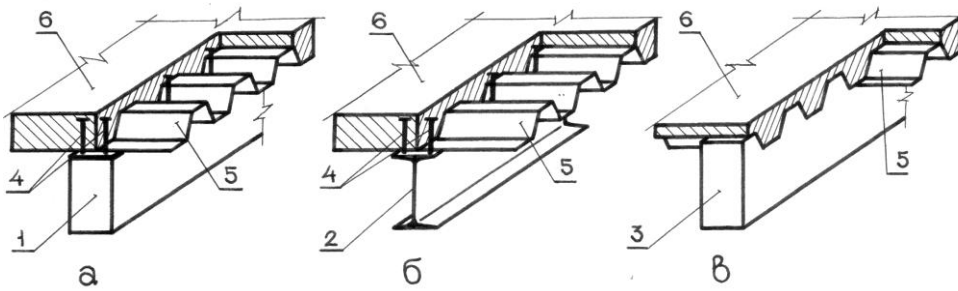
Комбіноване перекриття поверх профільованого настилу з використанням: а – сталевих залізобетонних балок; б – сталевих двотаврів; в – залізобетонних ригелів з уступами; 1 – залізобетонна балка; 2 – сталевий двотавр; 3 – залізобетонний ригель; 4 – анкерні штирі; 5 – профільований настил; 6 – залізобетонна плита.
